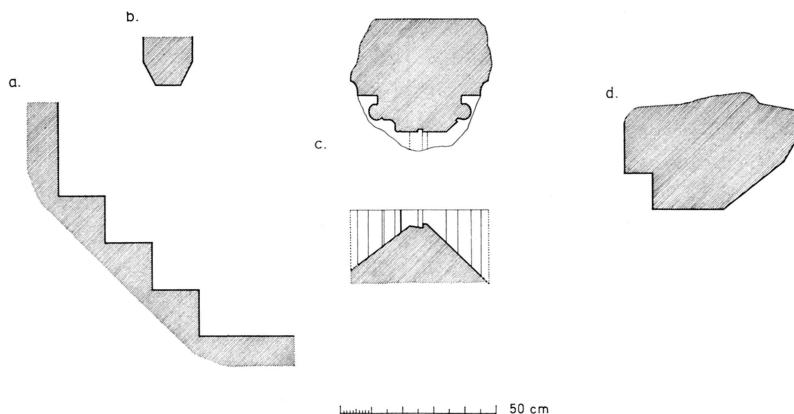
a. hörnknekt i norra korsarmen, b. profiltegel (ribba) från norra korsarmen, c. fönsterprofilsten, plan och elevation, d. profilerad sten, funnen norr om kyrkan, plan. Ritn. Lars Gezelius.
